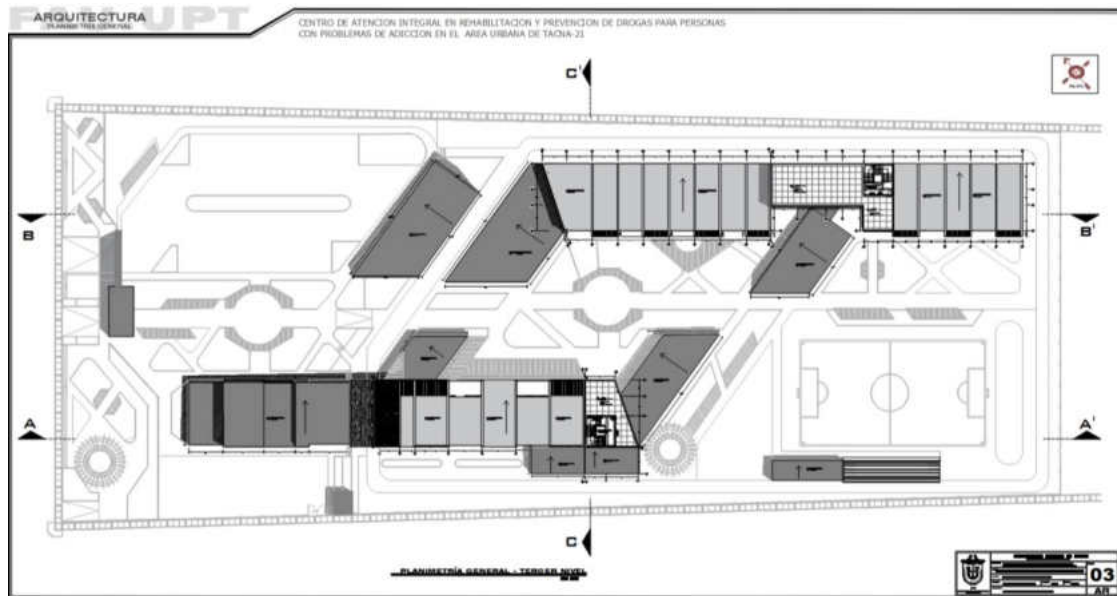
Planimetría general 3er piso, fuente elaboración propia.
